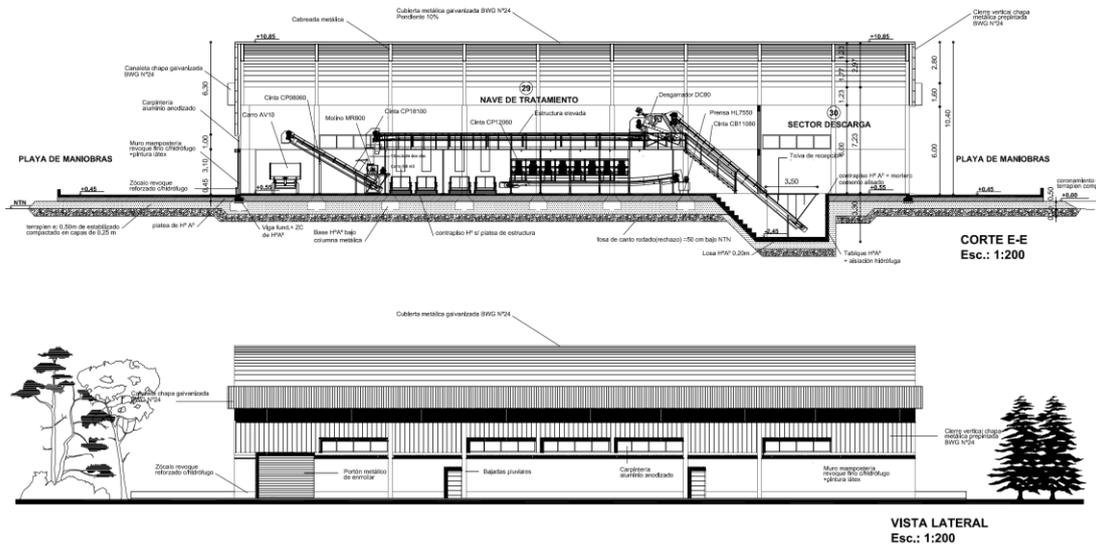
Corte y Alzada Lateral de la Planta de Separación
